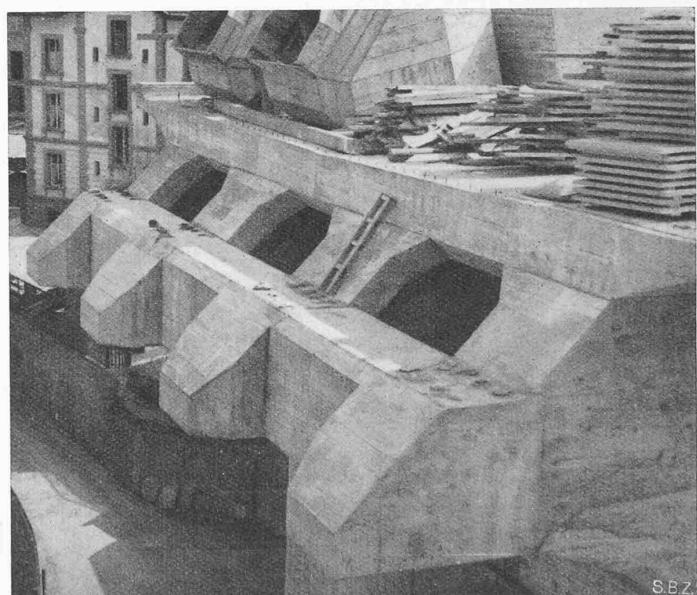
Fertig betonierte Auflagerbank (Pfeiler 4 in Los 2)
